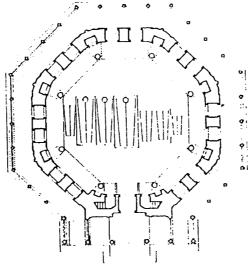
مسقط آفقى لترية حاجى سلطان في بورصة (عن : Wilde) .
